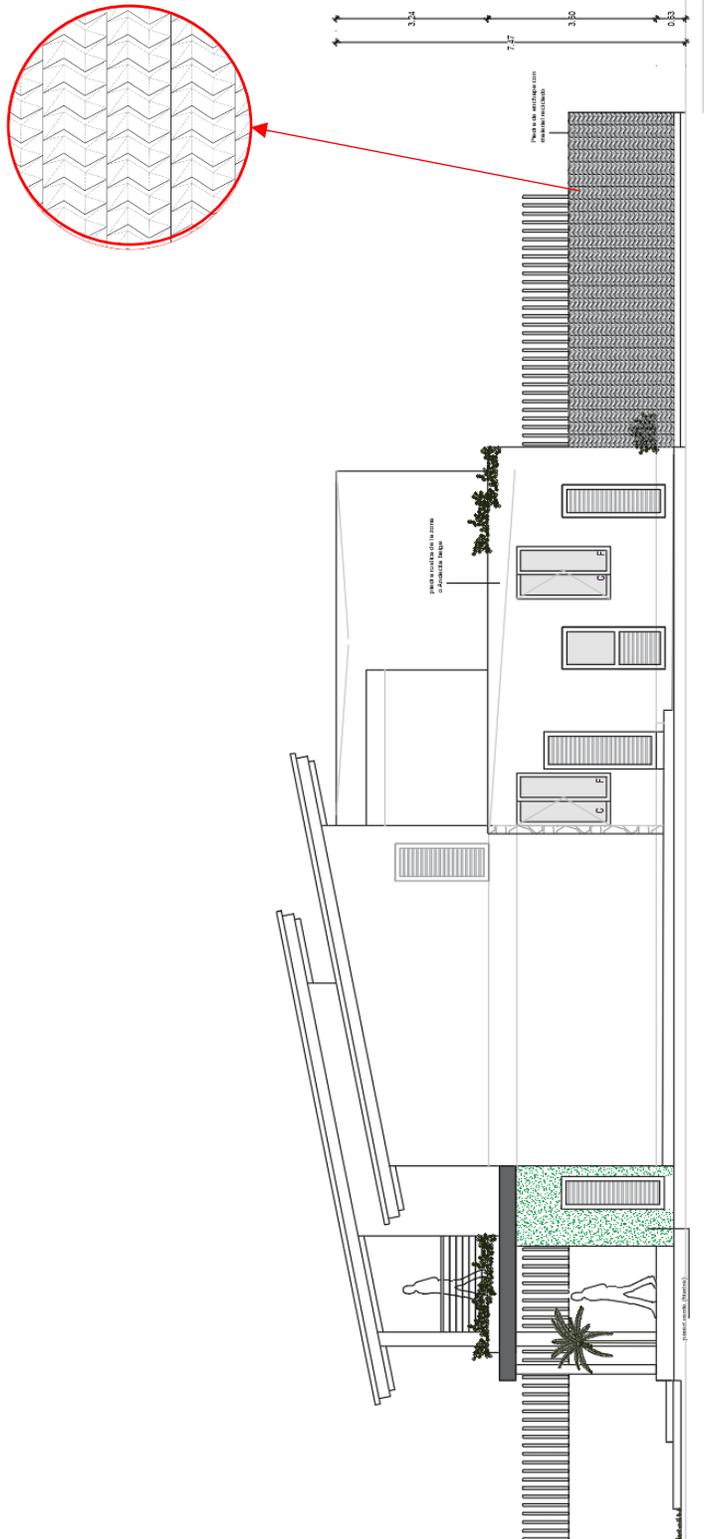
Aplicación de la piedra de enchape en fachada lateral (vivienda 1)
